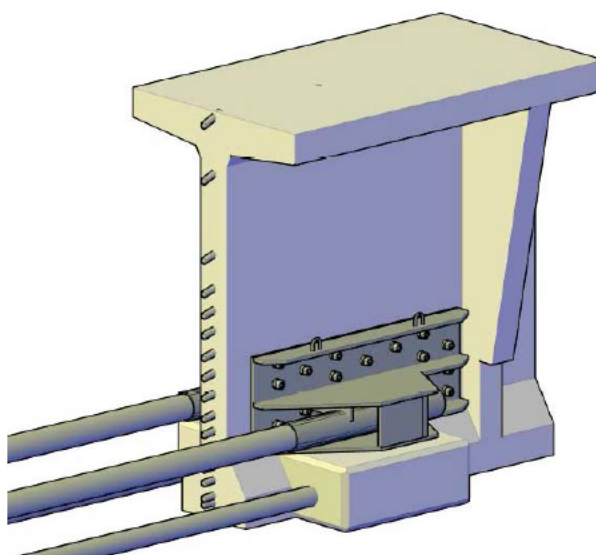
Poutres en béton – Renforcement par PTE2 (source : plans nomenclature PJCCI)
